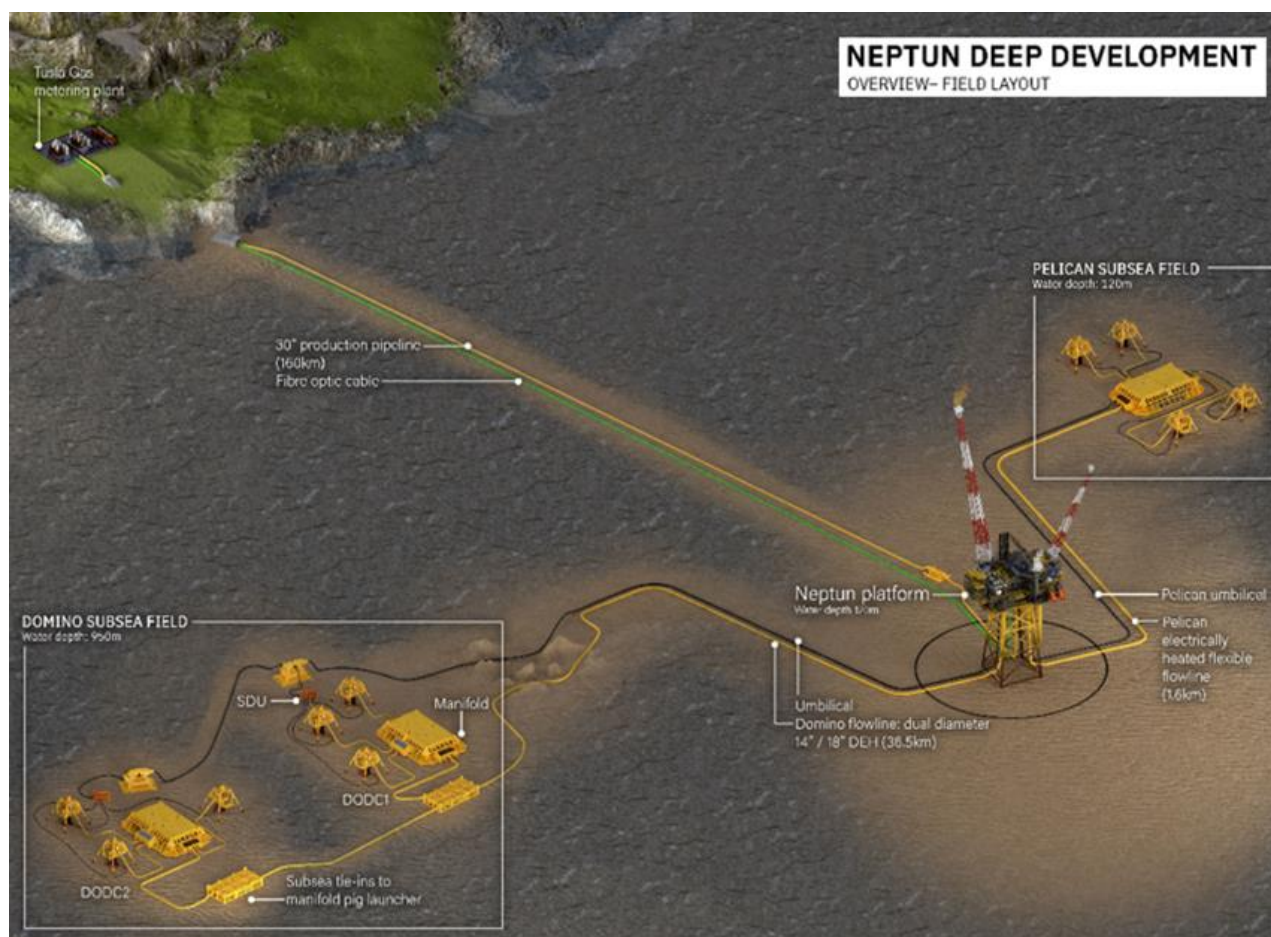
Plan de incadrare a proiectului Neptun Deep
